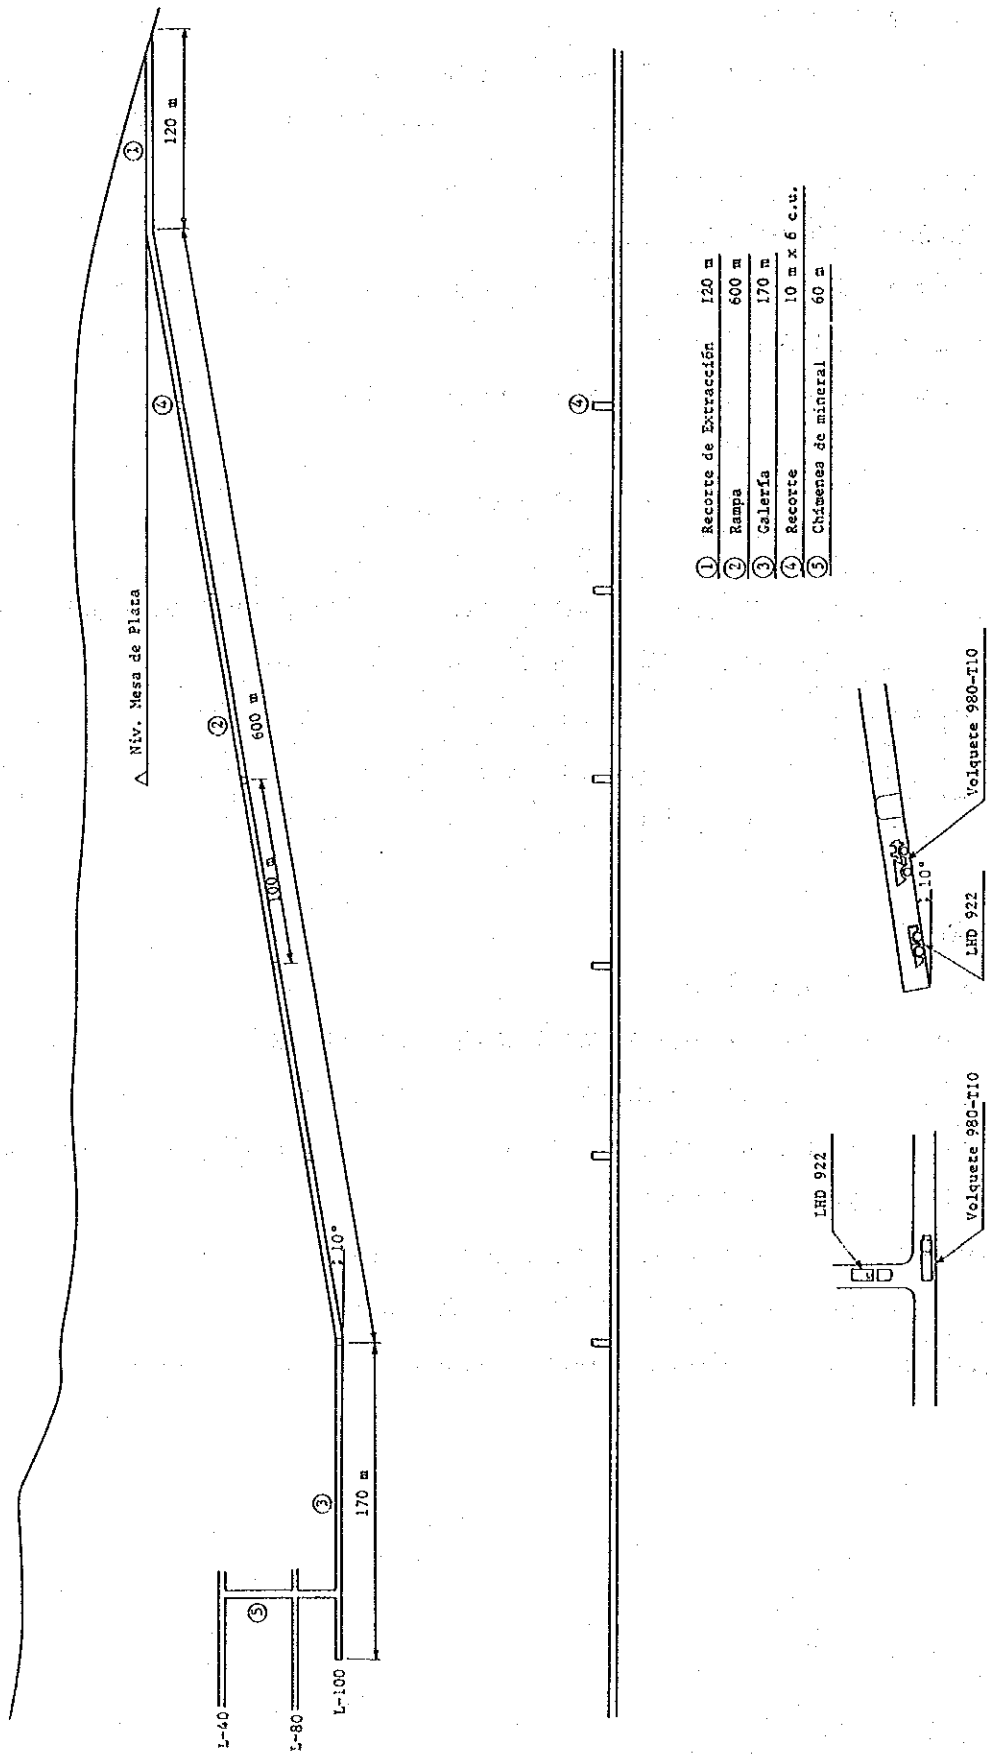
トラックレス斜坑平面図及び断面図 S-1/2,000
